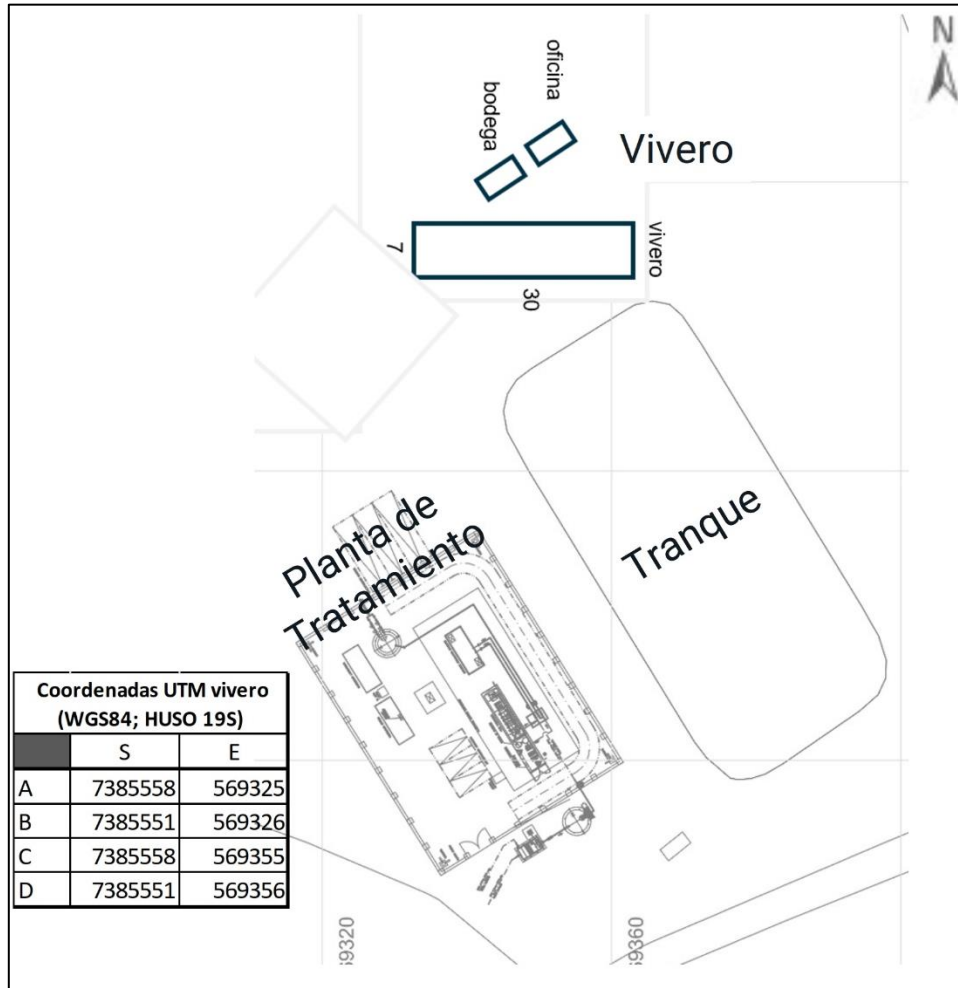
Plano de ubicación del vivero en la planta de Albemarle
